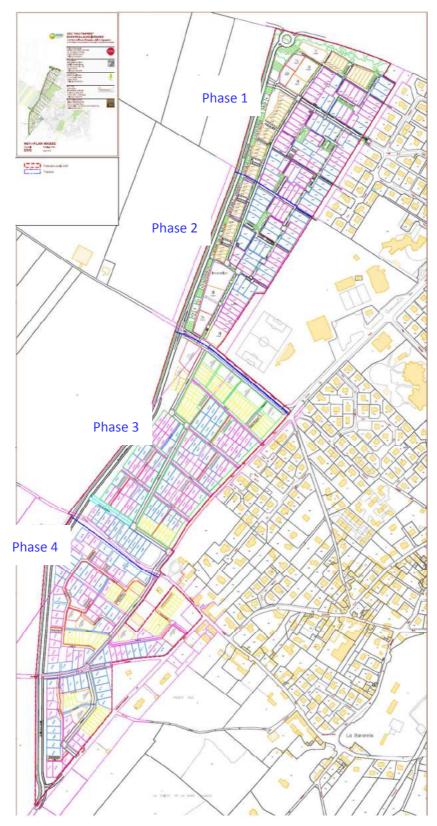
Plan d'ensemble de la ZAC des Hauts-Près
